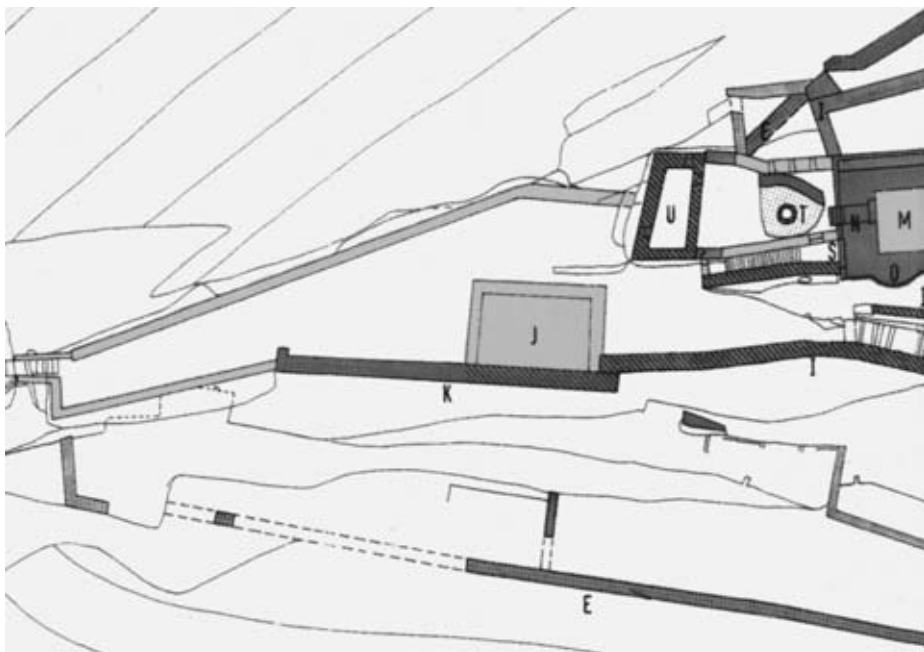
Grundriss der Burg Trifels (Ausschnitt). Aus: Meyer 2001: Beilage.
